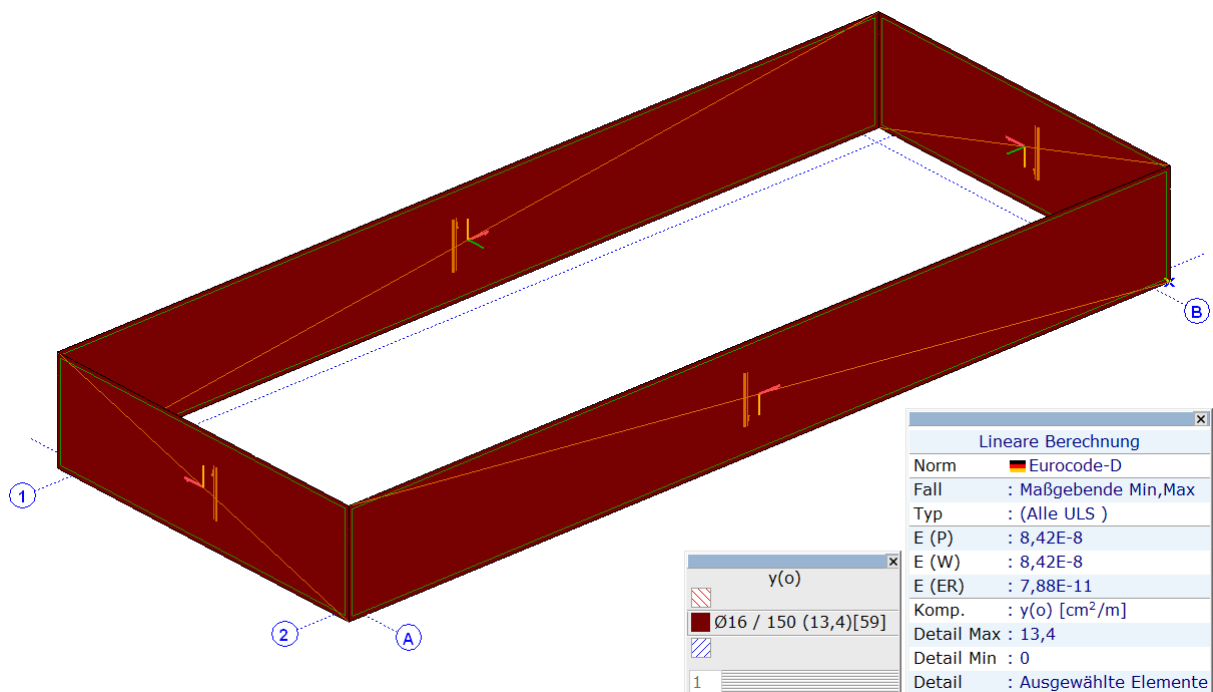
Entworfenere Bewehrung innen in lokaler y-Richtung (vertikal)
